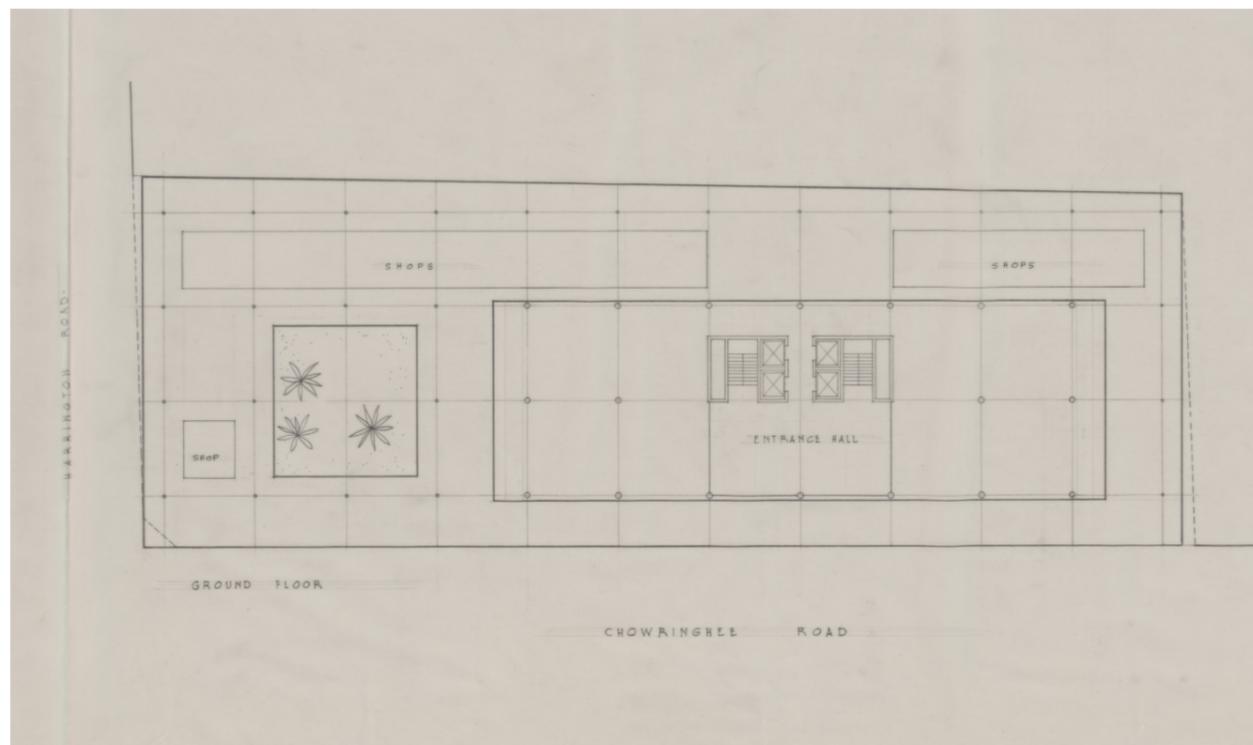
Alternative 3 (Grundriss), undatiert
